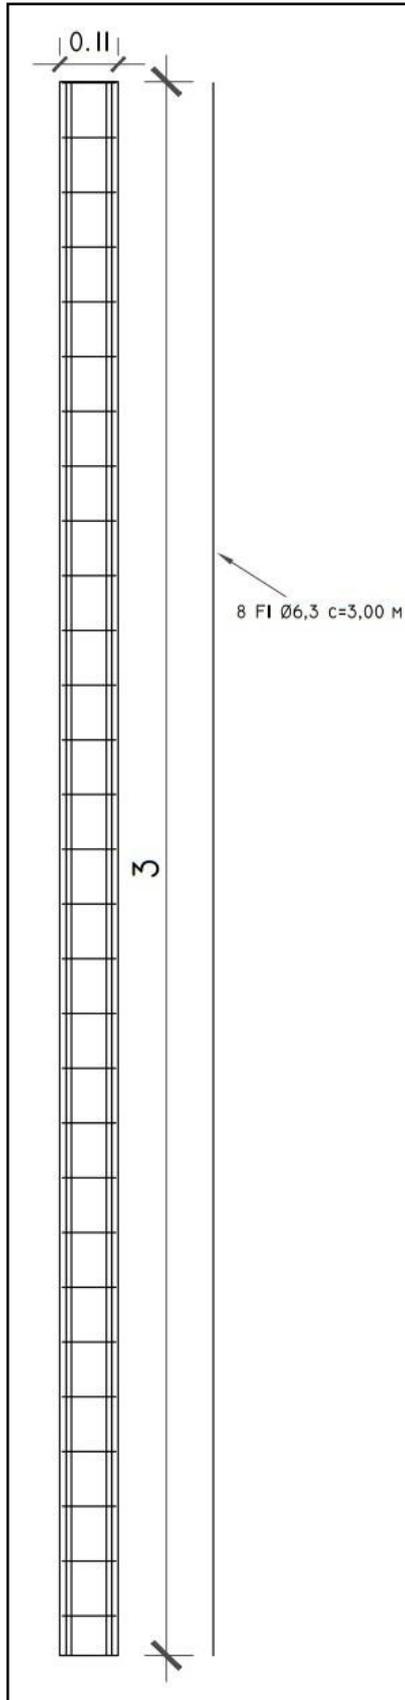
Detalhamento da armadura do Pilar A (11x11x300)
